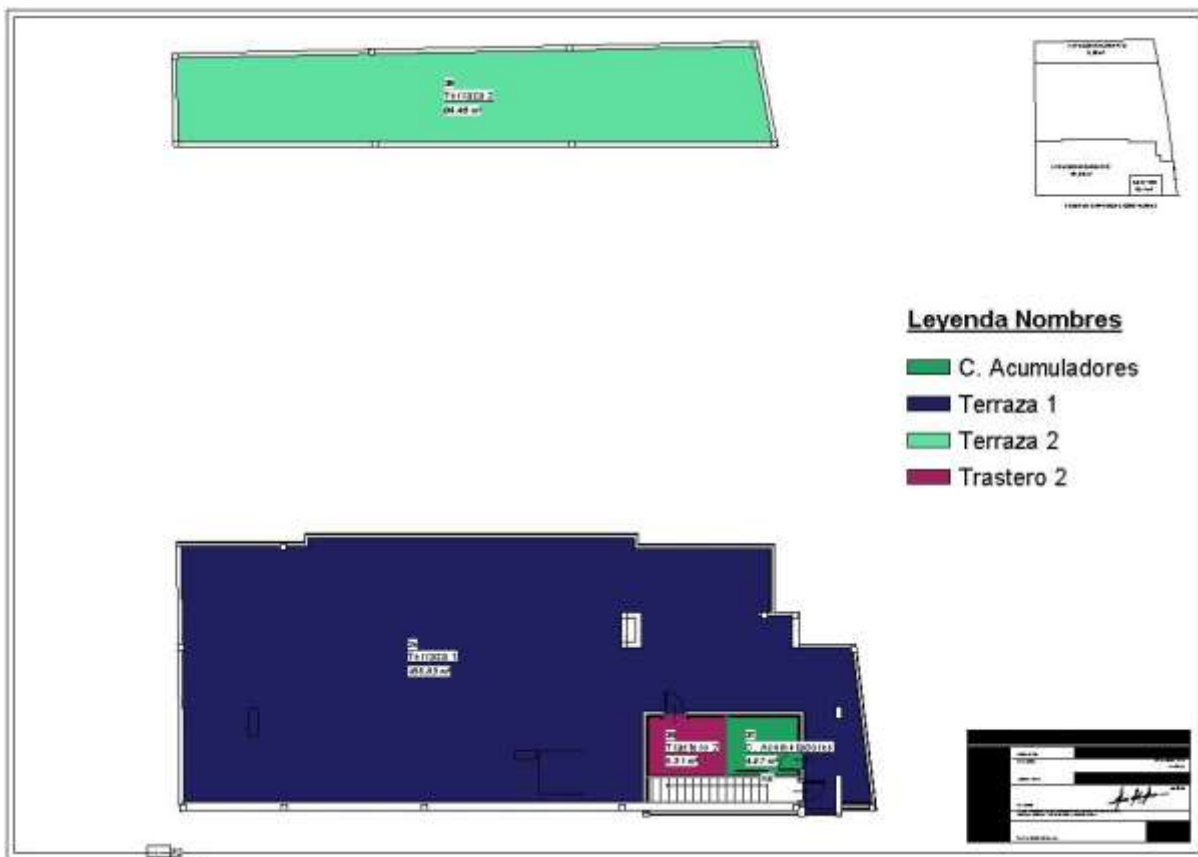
Plano de Superficies. Planta Segunda. Fuente propia. 2016
